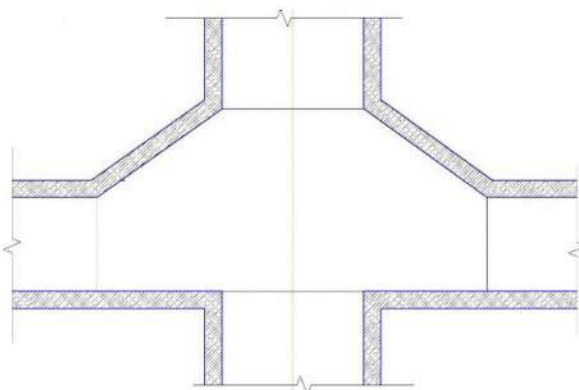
Сопряжение ствола с выработками околоствольного двора
